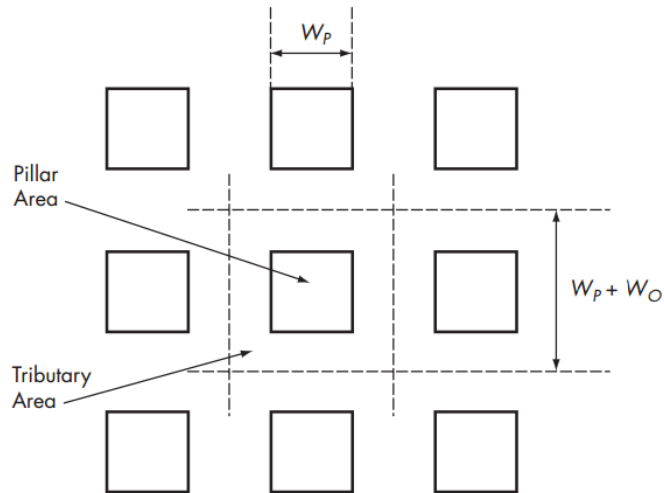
Vista en planta de una mina explotada por Room & Pillar.
